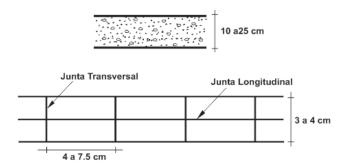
Pavimento de Concreto Hidráulico Fuente: Acurio, 2012
